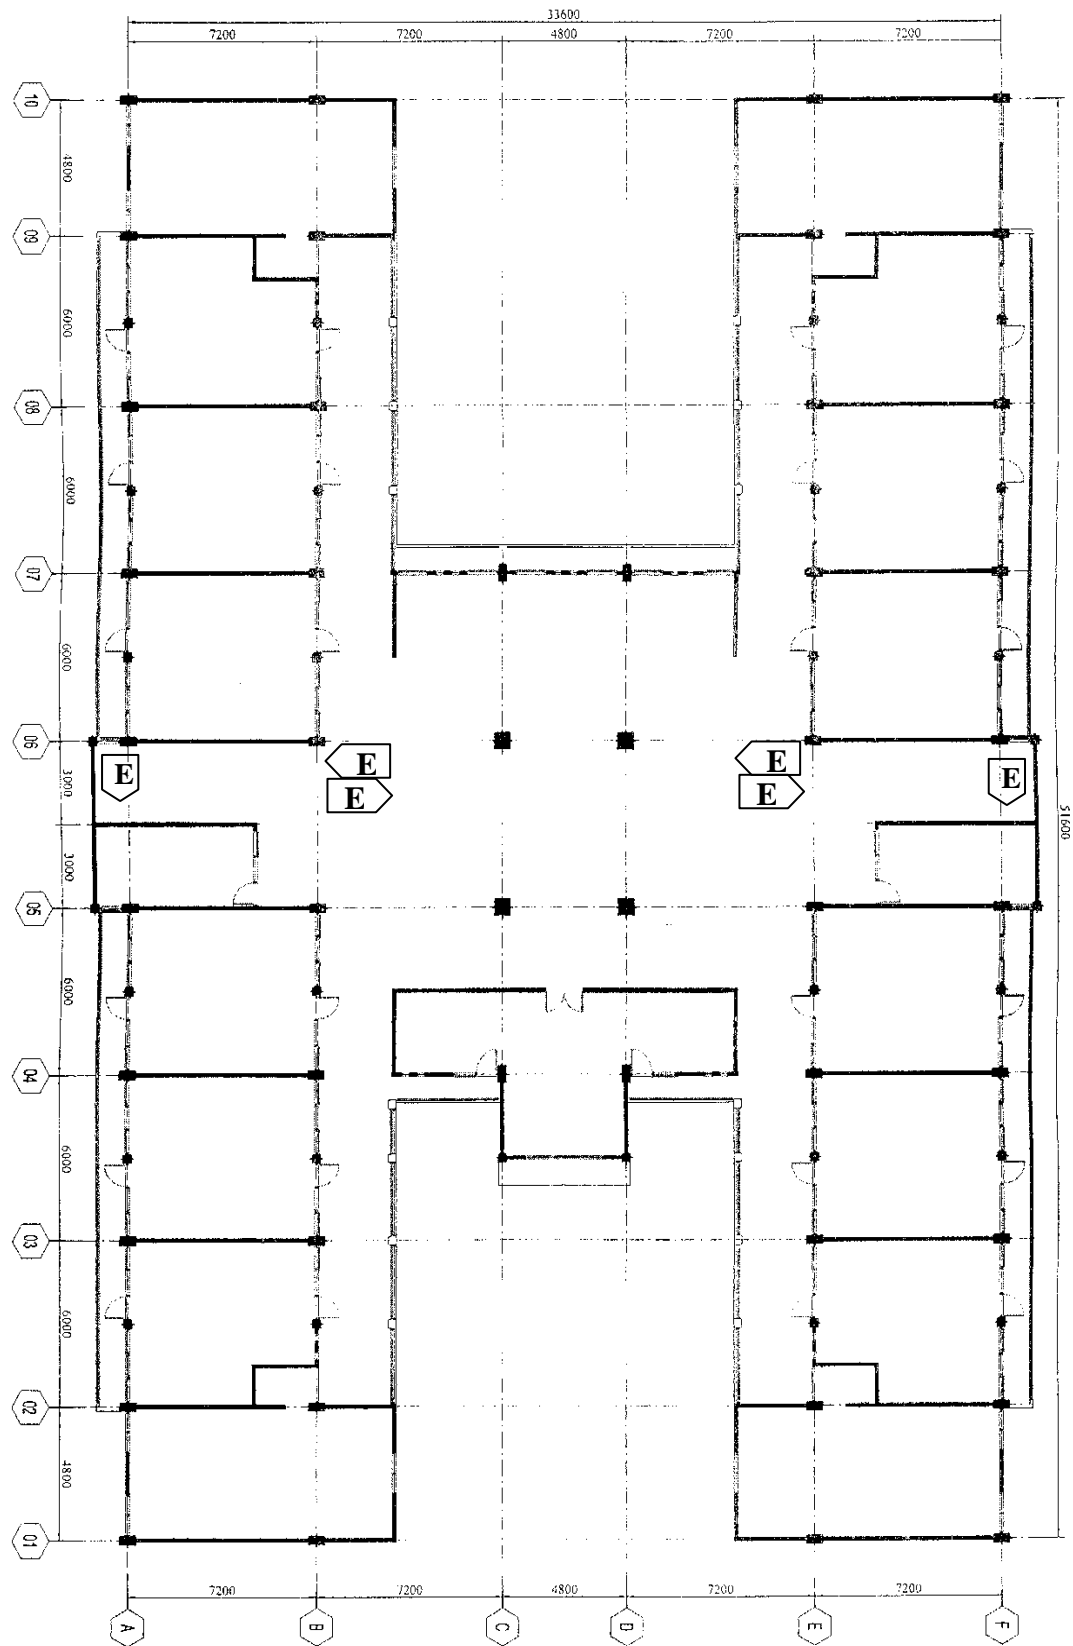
Pemasangan Petunjuk Arah Lantai 1
